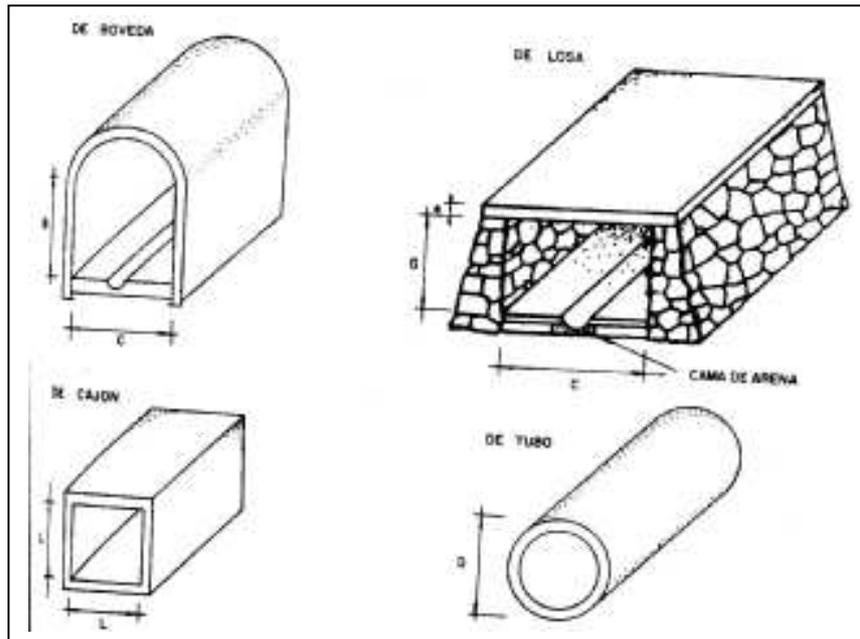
5 DIFERENTES TIPOS DE ALCANTARILLAS
